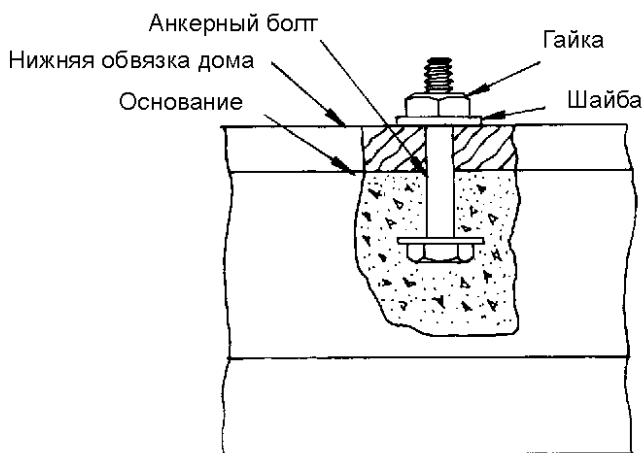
Металлические анкеры для крепления рамных конструкций
